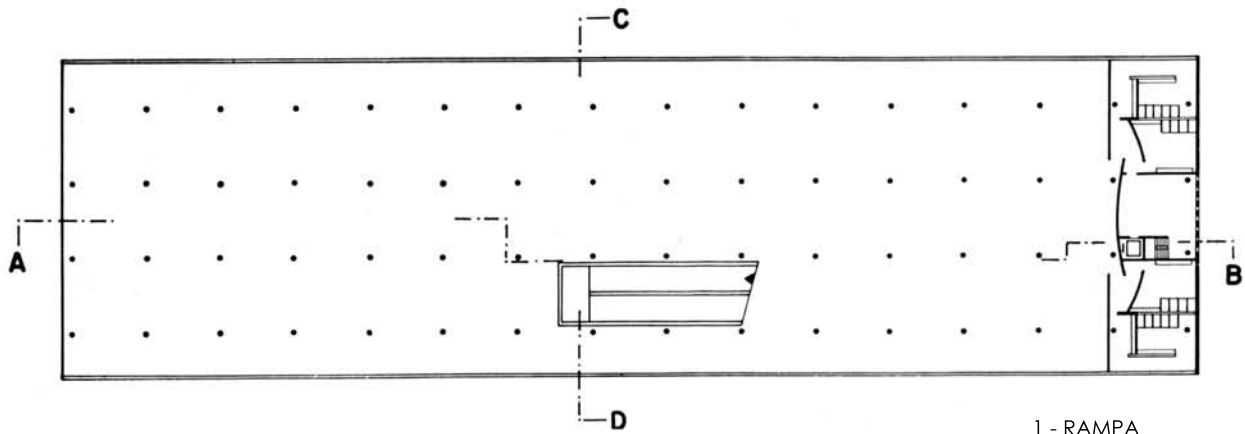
PALÁCIO DOS ESTADOS - 2.º PAV. - PLANTA BAIXA
